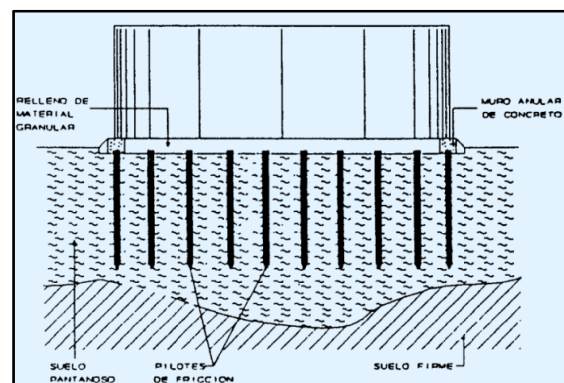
Cimentación flexible sobre pilotes de fricción o mixtos
